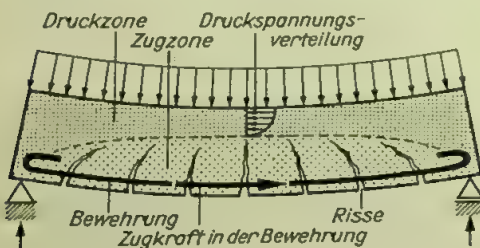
Wirkungsweise eines biegebeanspruchten Stahlbetonbauteils
